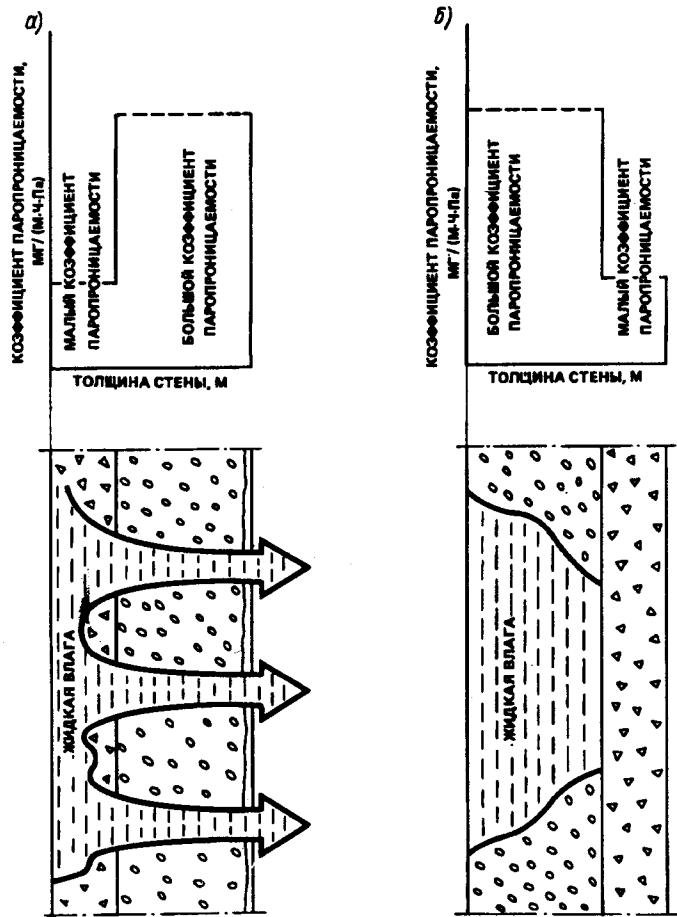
Условия высыхания и отсыревания конструкций двухслойной наружной стены
